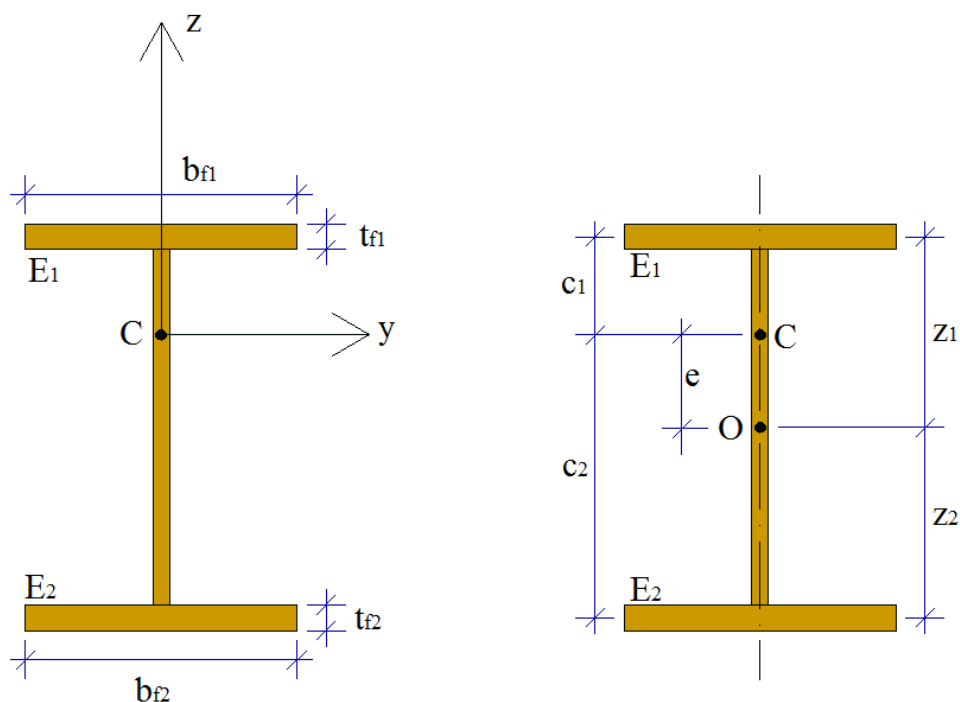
Centro de flexão e centróide da seção transversal da viga I.
